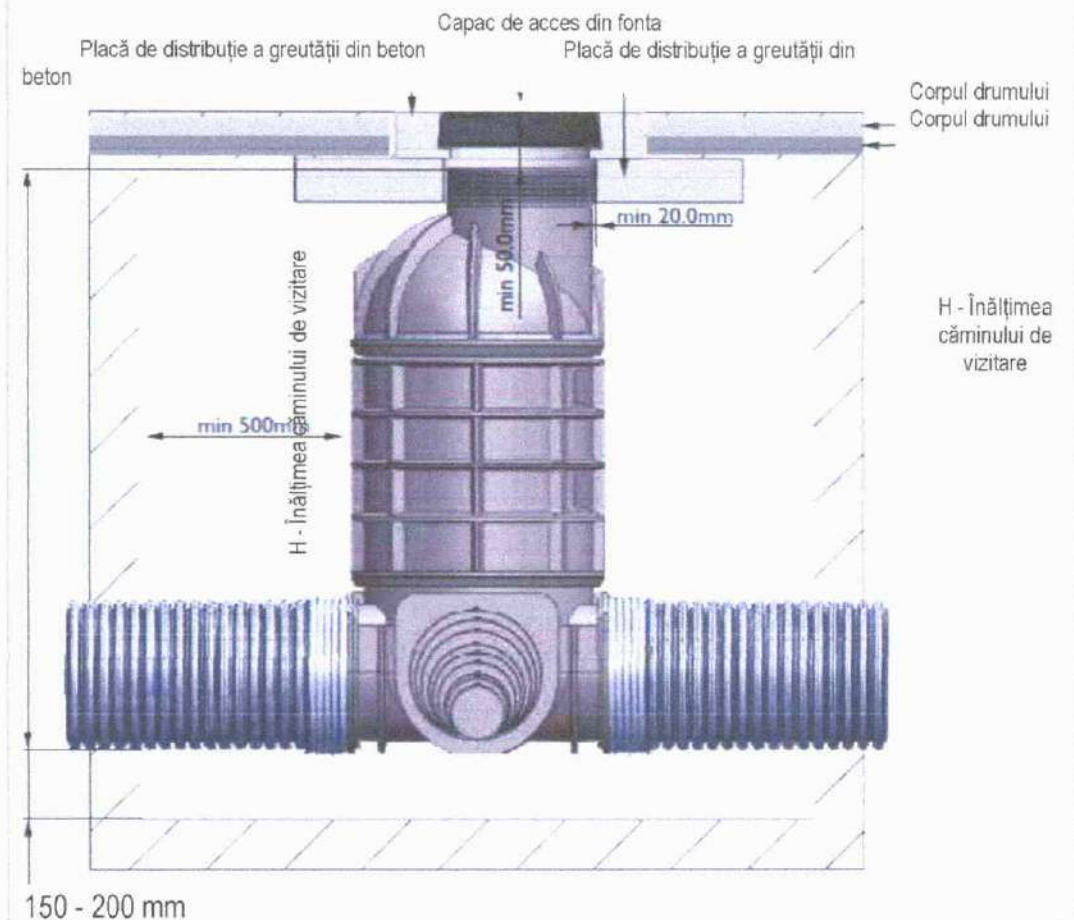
Asamblarea țevilor profilate PP sau PE în cămine de vizitare din beton
